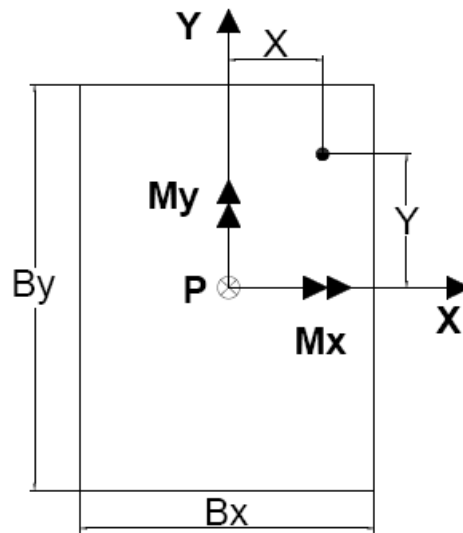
Planta de una fundación sometida a carga vertical y momentos
